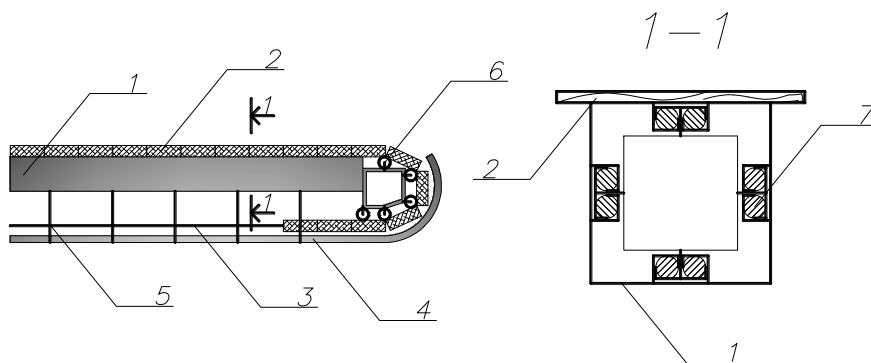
Схема автоматического изменения размеров рабочего настила: 1 - несущая балка рабочего настила; 2 - рабочий настил; 3 - канат; 4 - металлическая направляющая; 5 - поддерживающие стойки; 6 - шарнир; 7 - шарнир, снижающий трение
